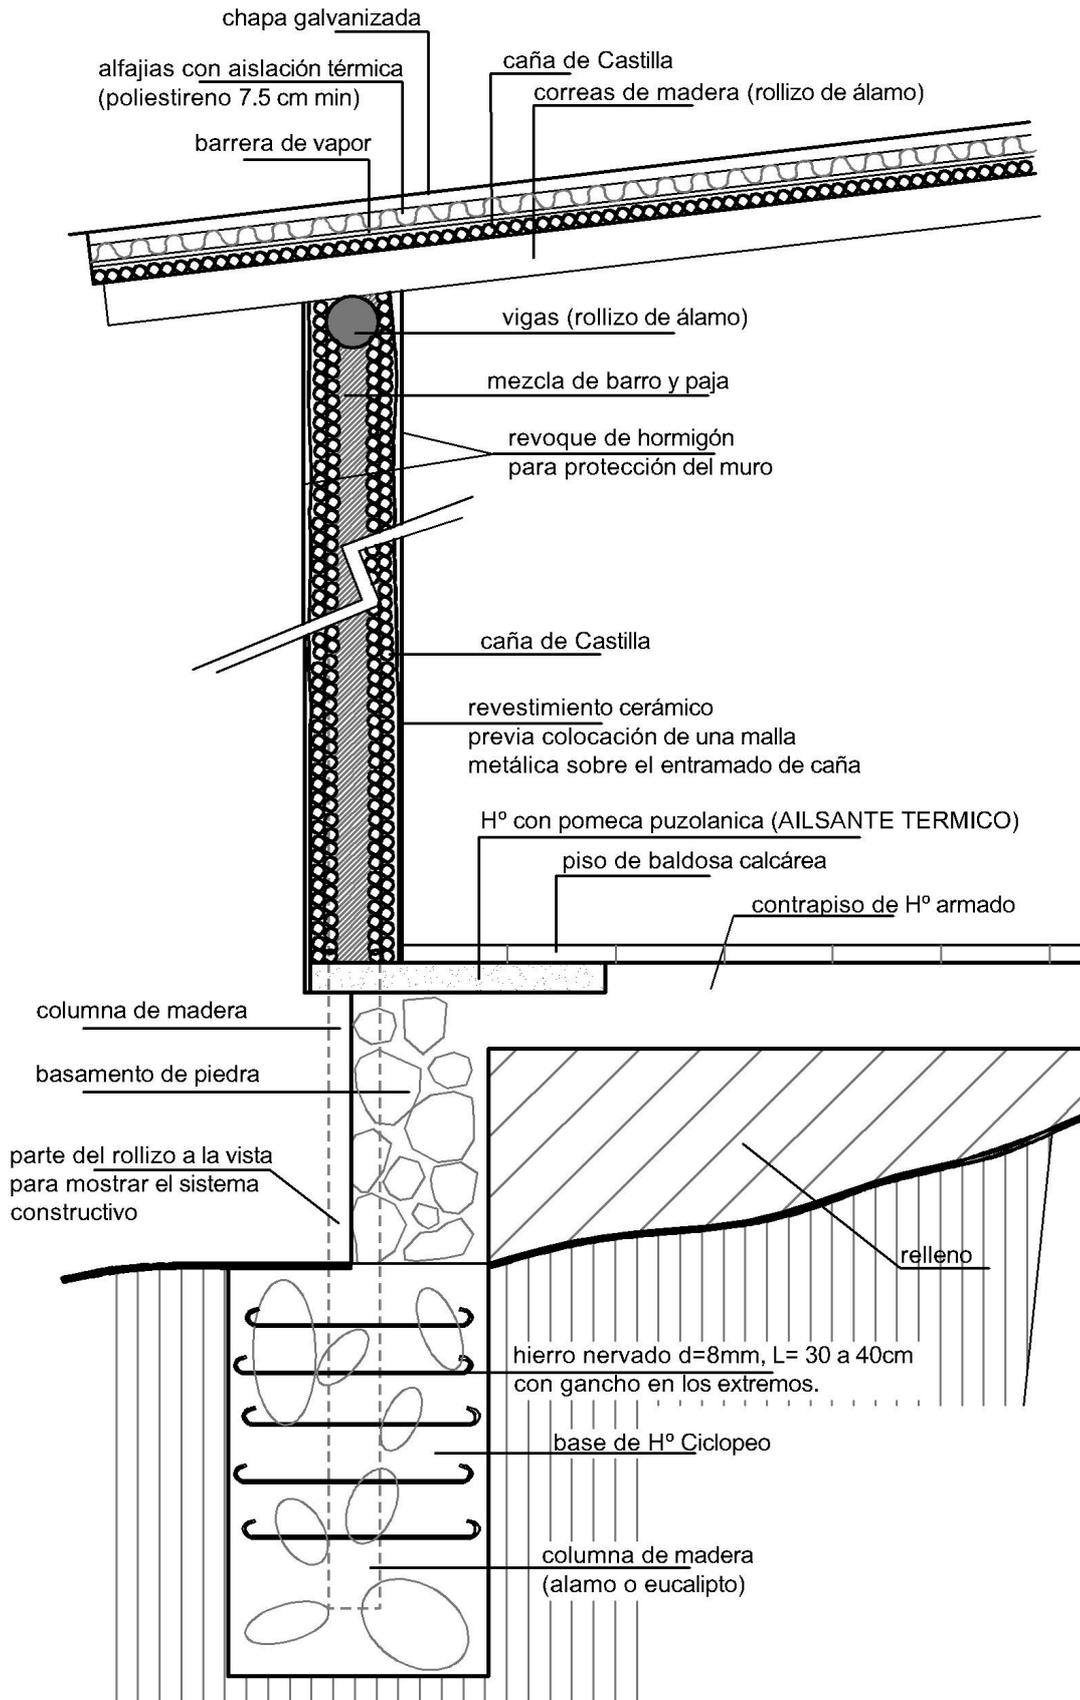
Detalle constructivo donde se muestra la conformación del muro de acuerdo al sistema constructivo propuesto.
